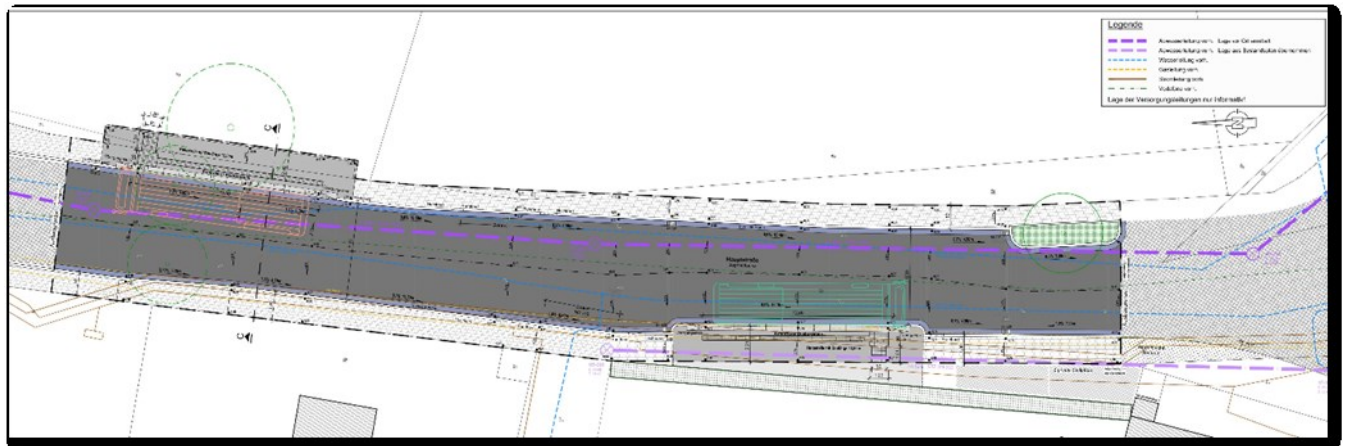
Lageplan barrierefreie Haltestelle Hauptstraße
